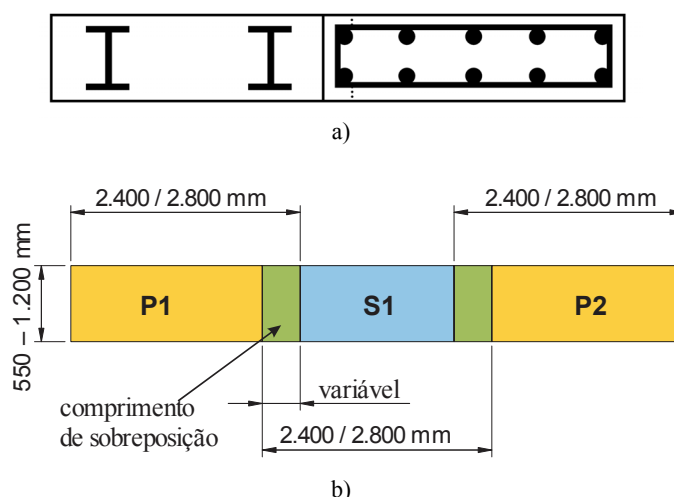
a) Painel CSM, com perfis metálicos ou armadura (Fiorotto *et al.*, 2005); b) Dimensões em planta dos painéis CSM (adaptado de Bauer, 2010)
